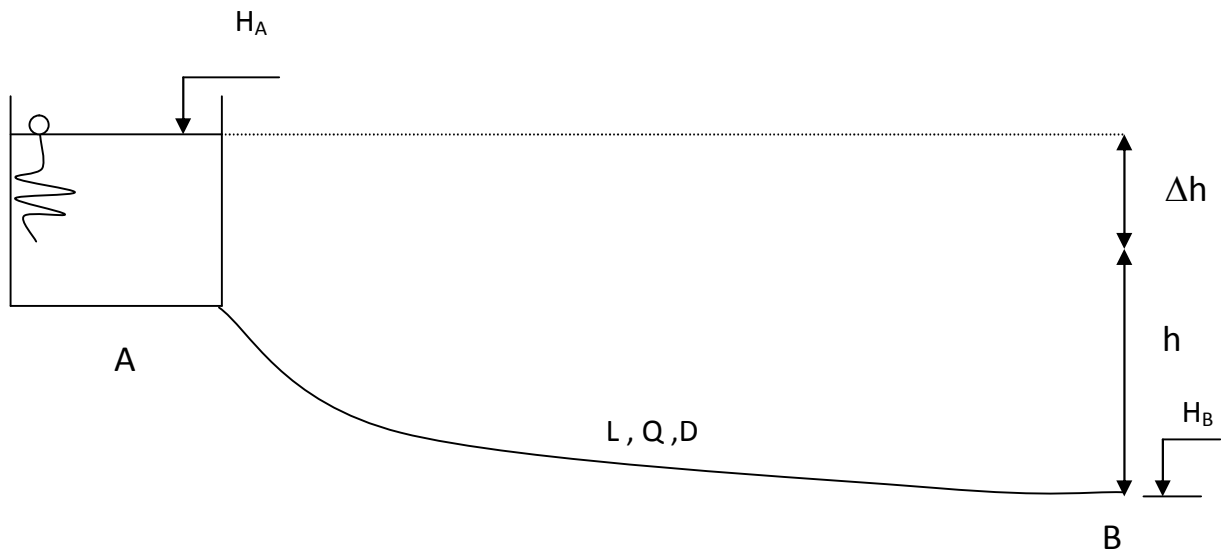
schéma d'une conduite à service d'extrémité
